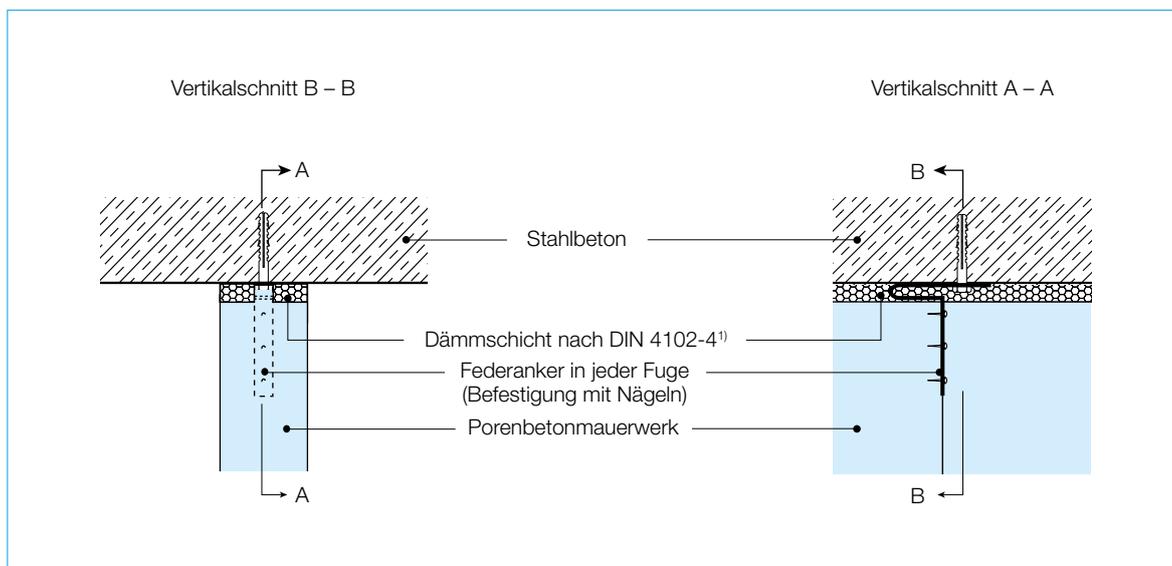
Brandschutztechnischer Anschluss einer nicht tragenden Wand aus Porenbetonmauerwerk an eine Stahlbetondecke mit Federankern
